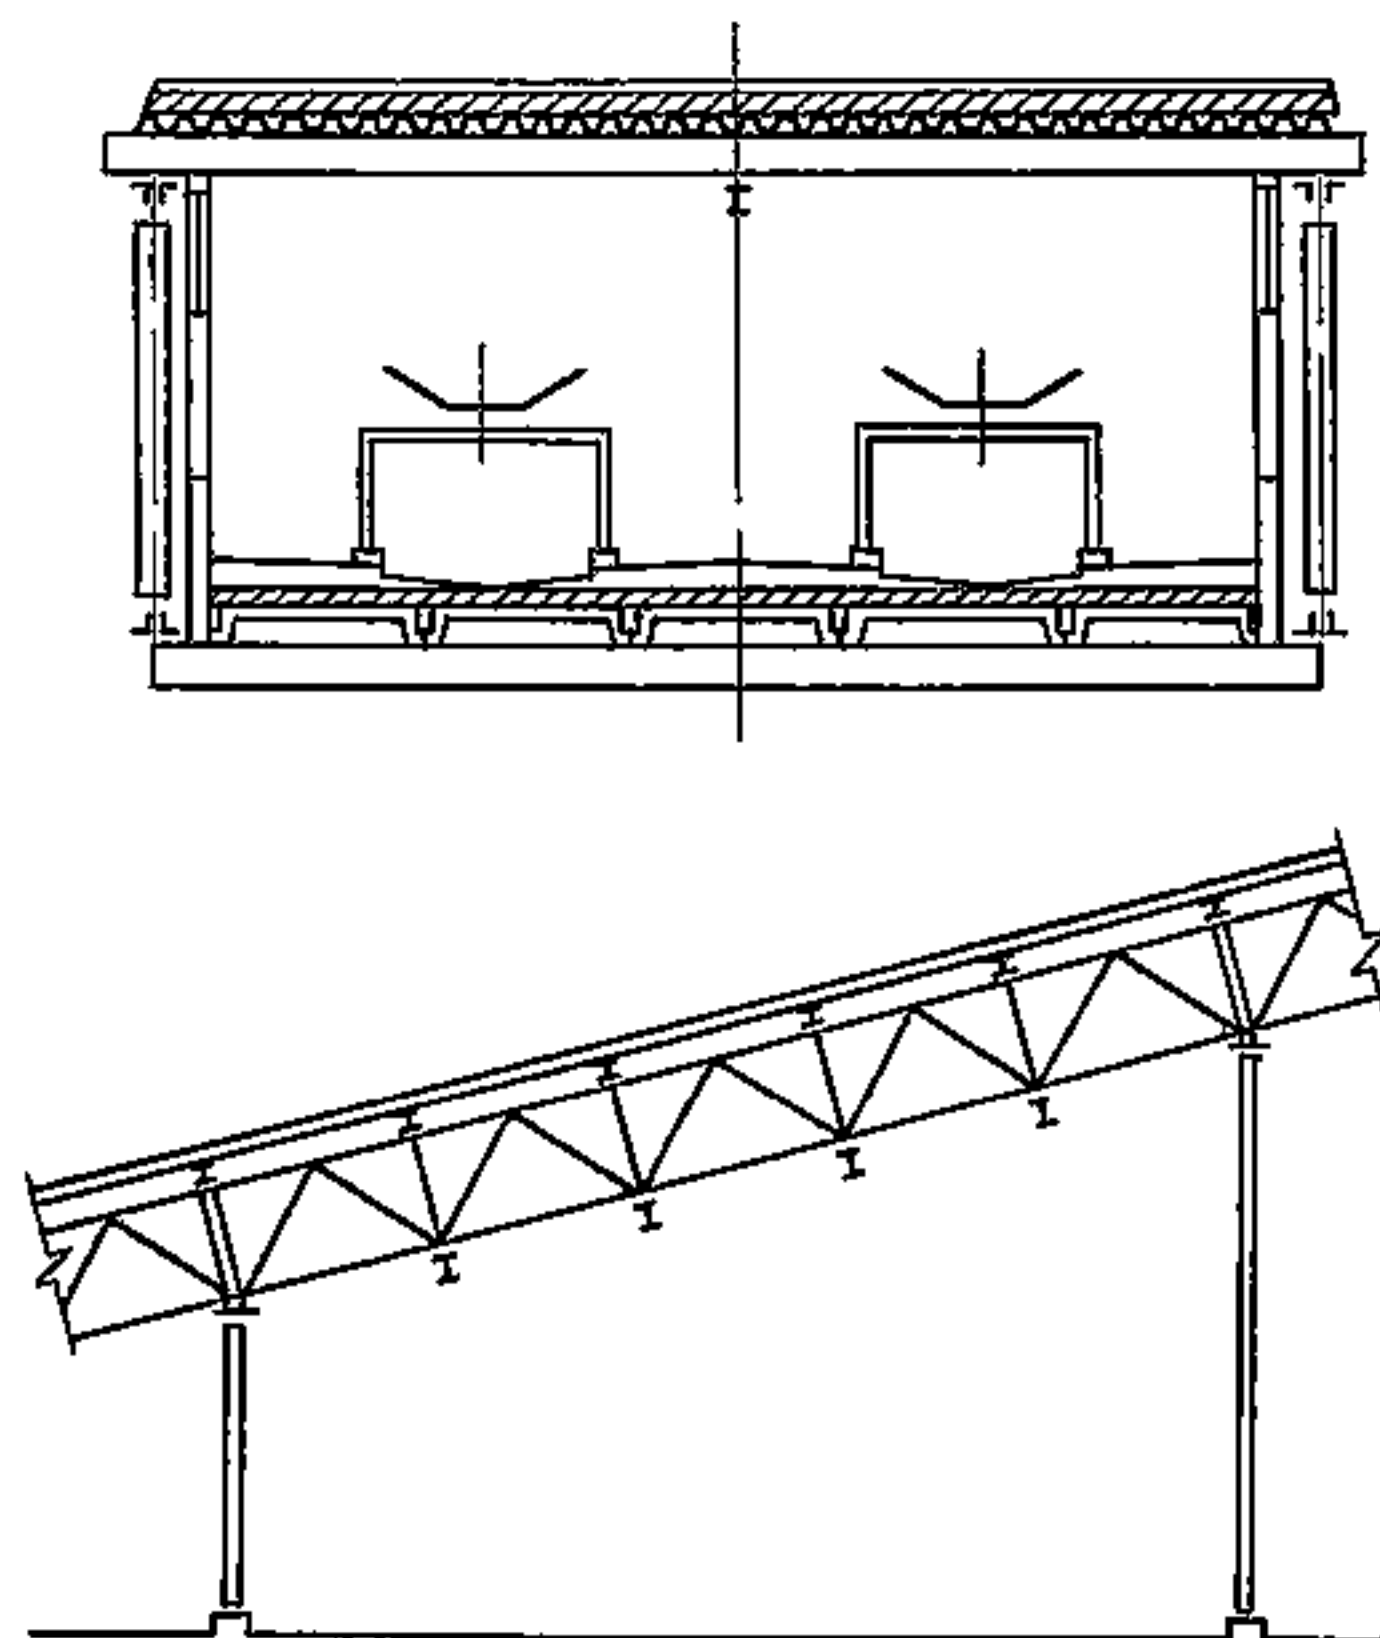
Пролетное строение конвейерной галереи с несущими конструкциями из ферм с параллельными поясами
